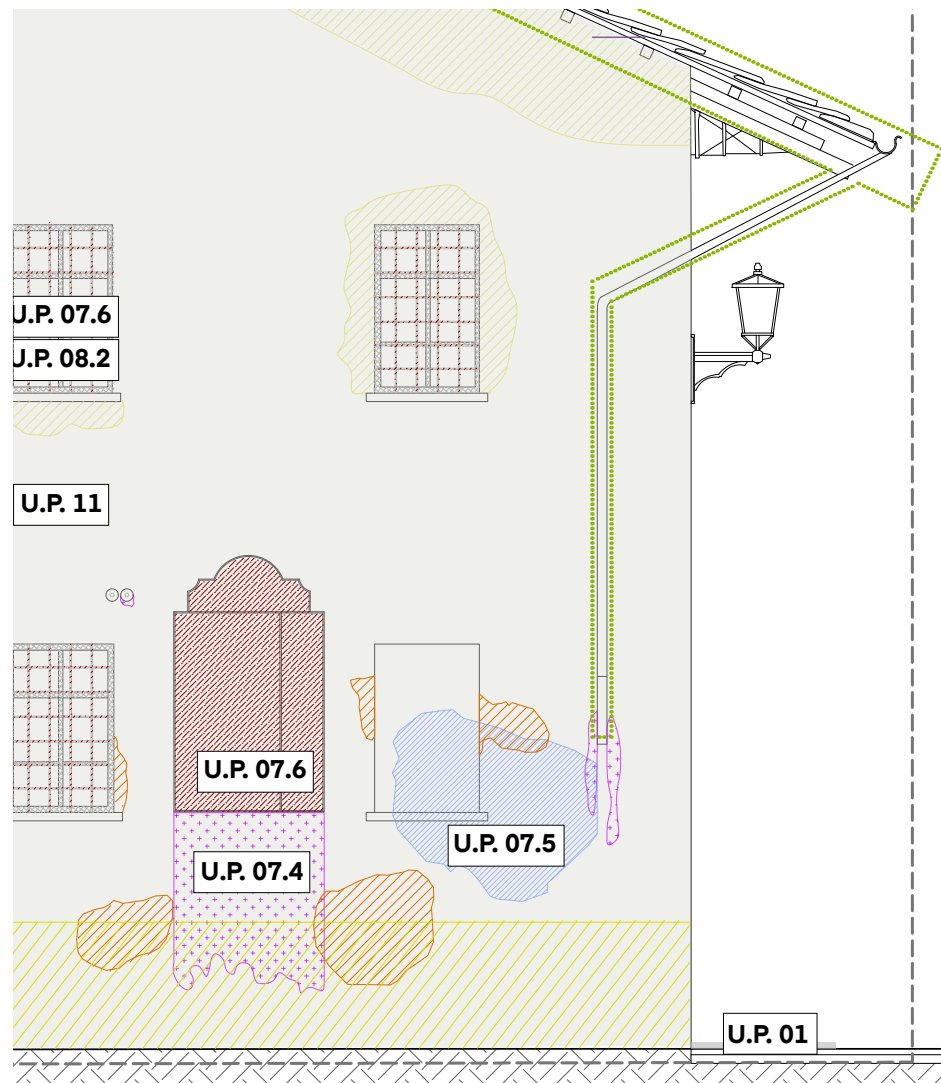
Stralcio di tavola degli interventi di progetto sul prospetto est (tav. 13).
